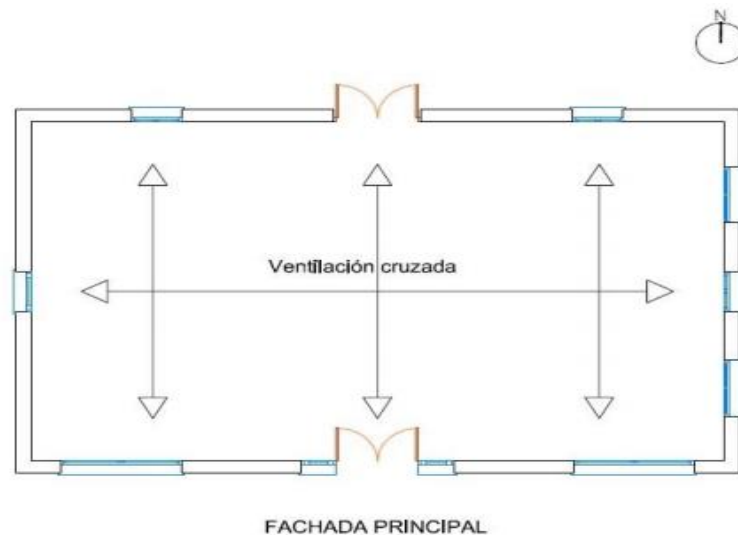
Disposición de Aperturas y Orientación Fachadas.
